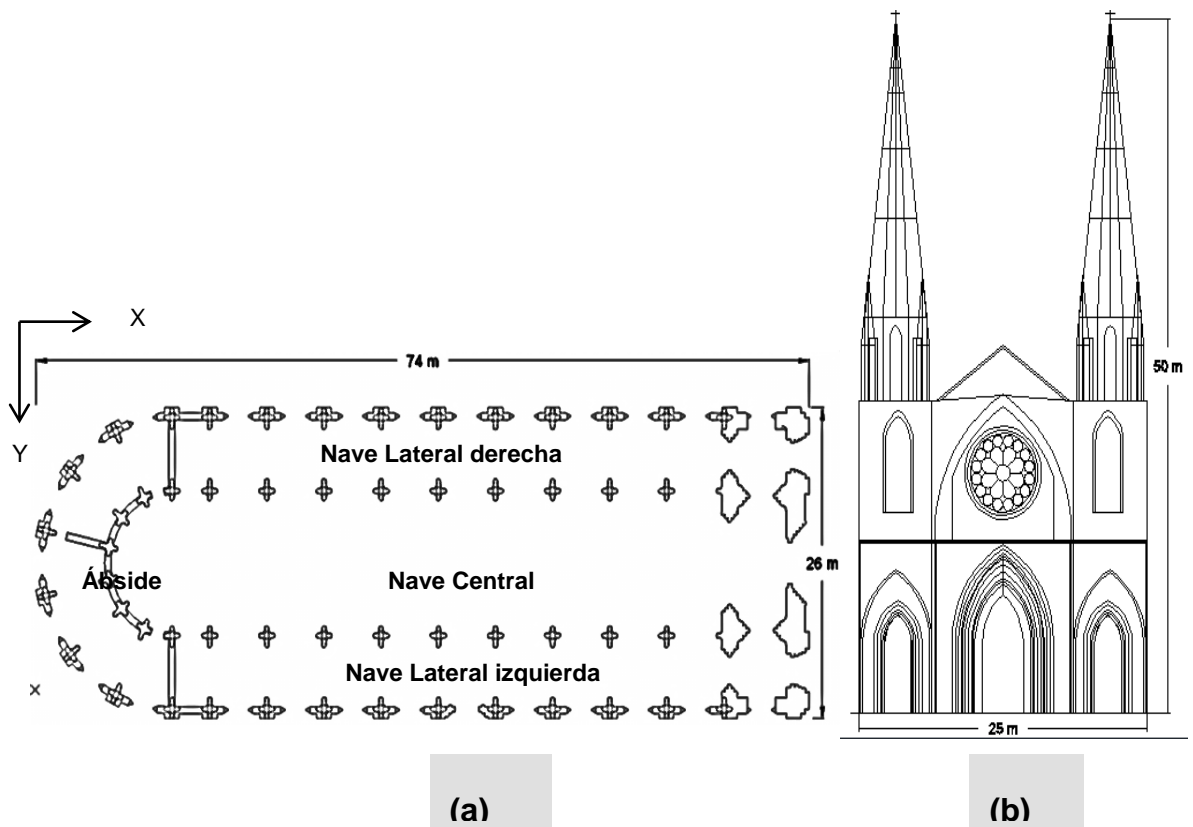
Construcción fachada principal y ábside. Fuente: (Franciscanos de Bucaramanga, 2012)
